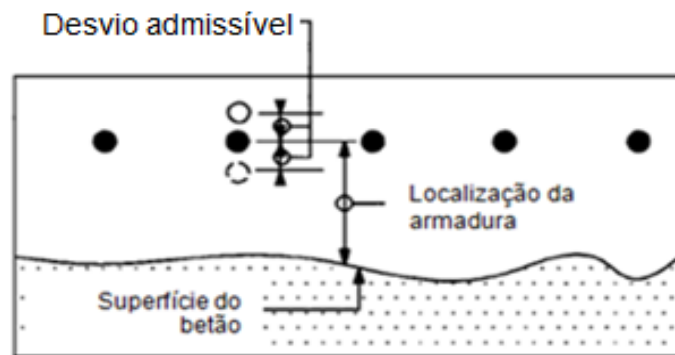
Ilustração do desvio vertical da armadura numa laje de fundação (adaptado da Fig. R2.2.3 [11]).
